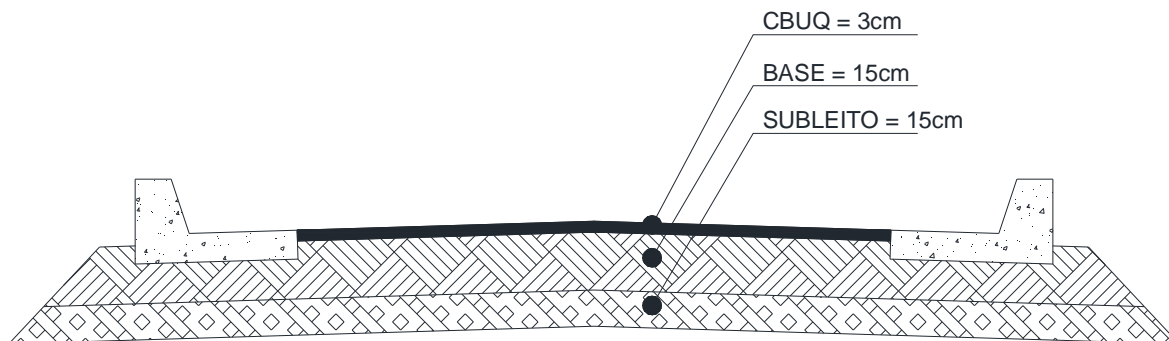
Seção do pavimento para vias locais (Tráfego Leve).
